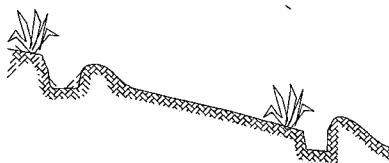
Sembrado de Plantas en el Borde Superior de las Zanjas de Infiltración.
